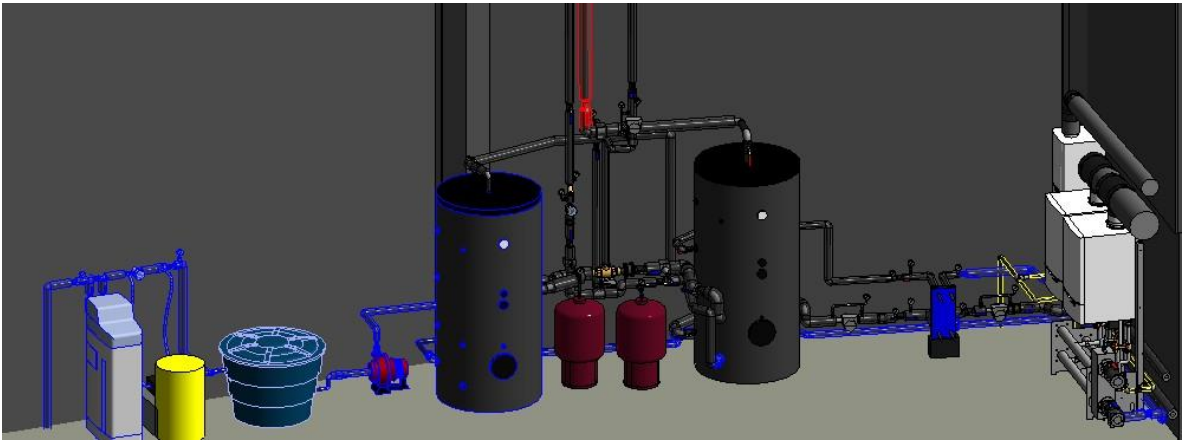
Vista en planta de la sala de instalaciones.
